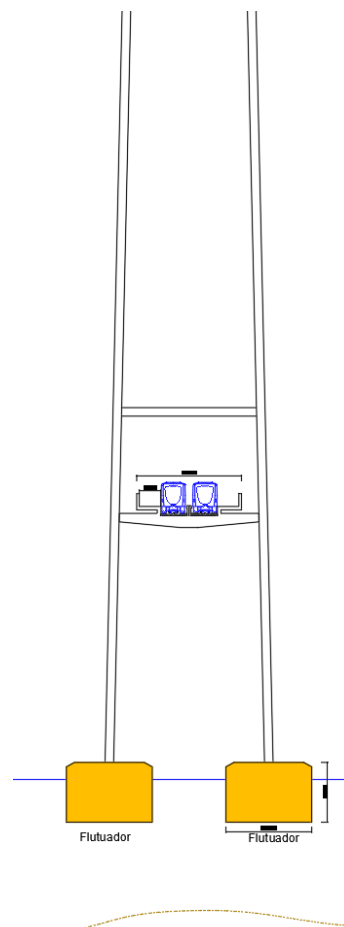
Ponte - Zona atirantada (Seção Transversal)
